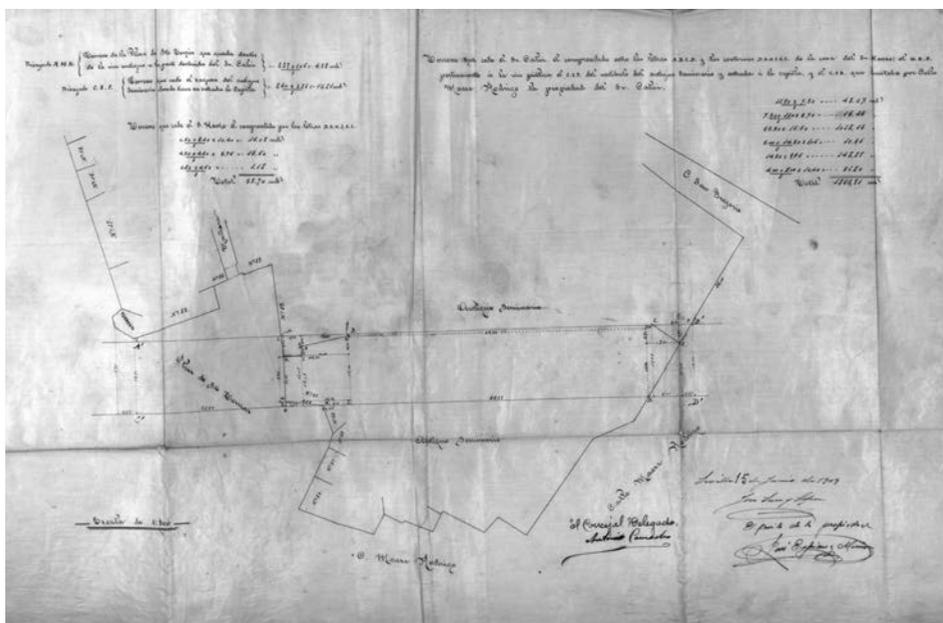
Plano de replanteo de la apertura de la Avenida sobre la manzana de Santa María de Jesús. Expediente formado para reconstruir el antiguo Seminario Conciliar. ICAS-SAHP, AHMS. Construcciones y Reconstrucciones 2-3-50, año 1909.
